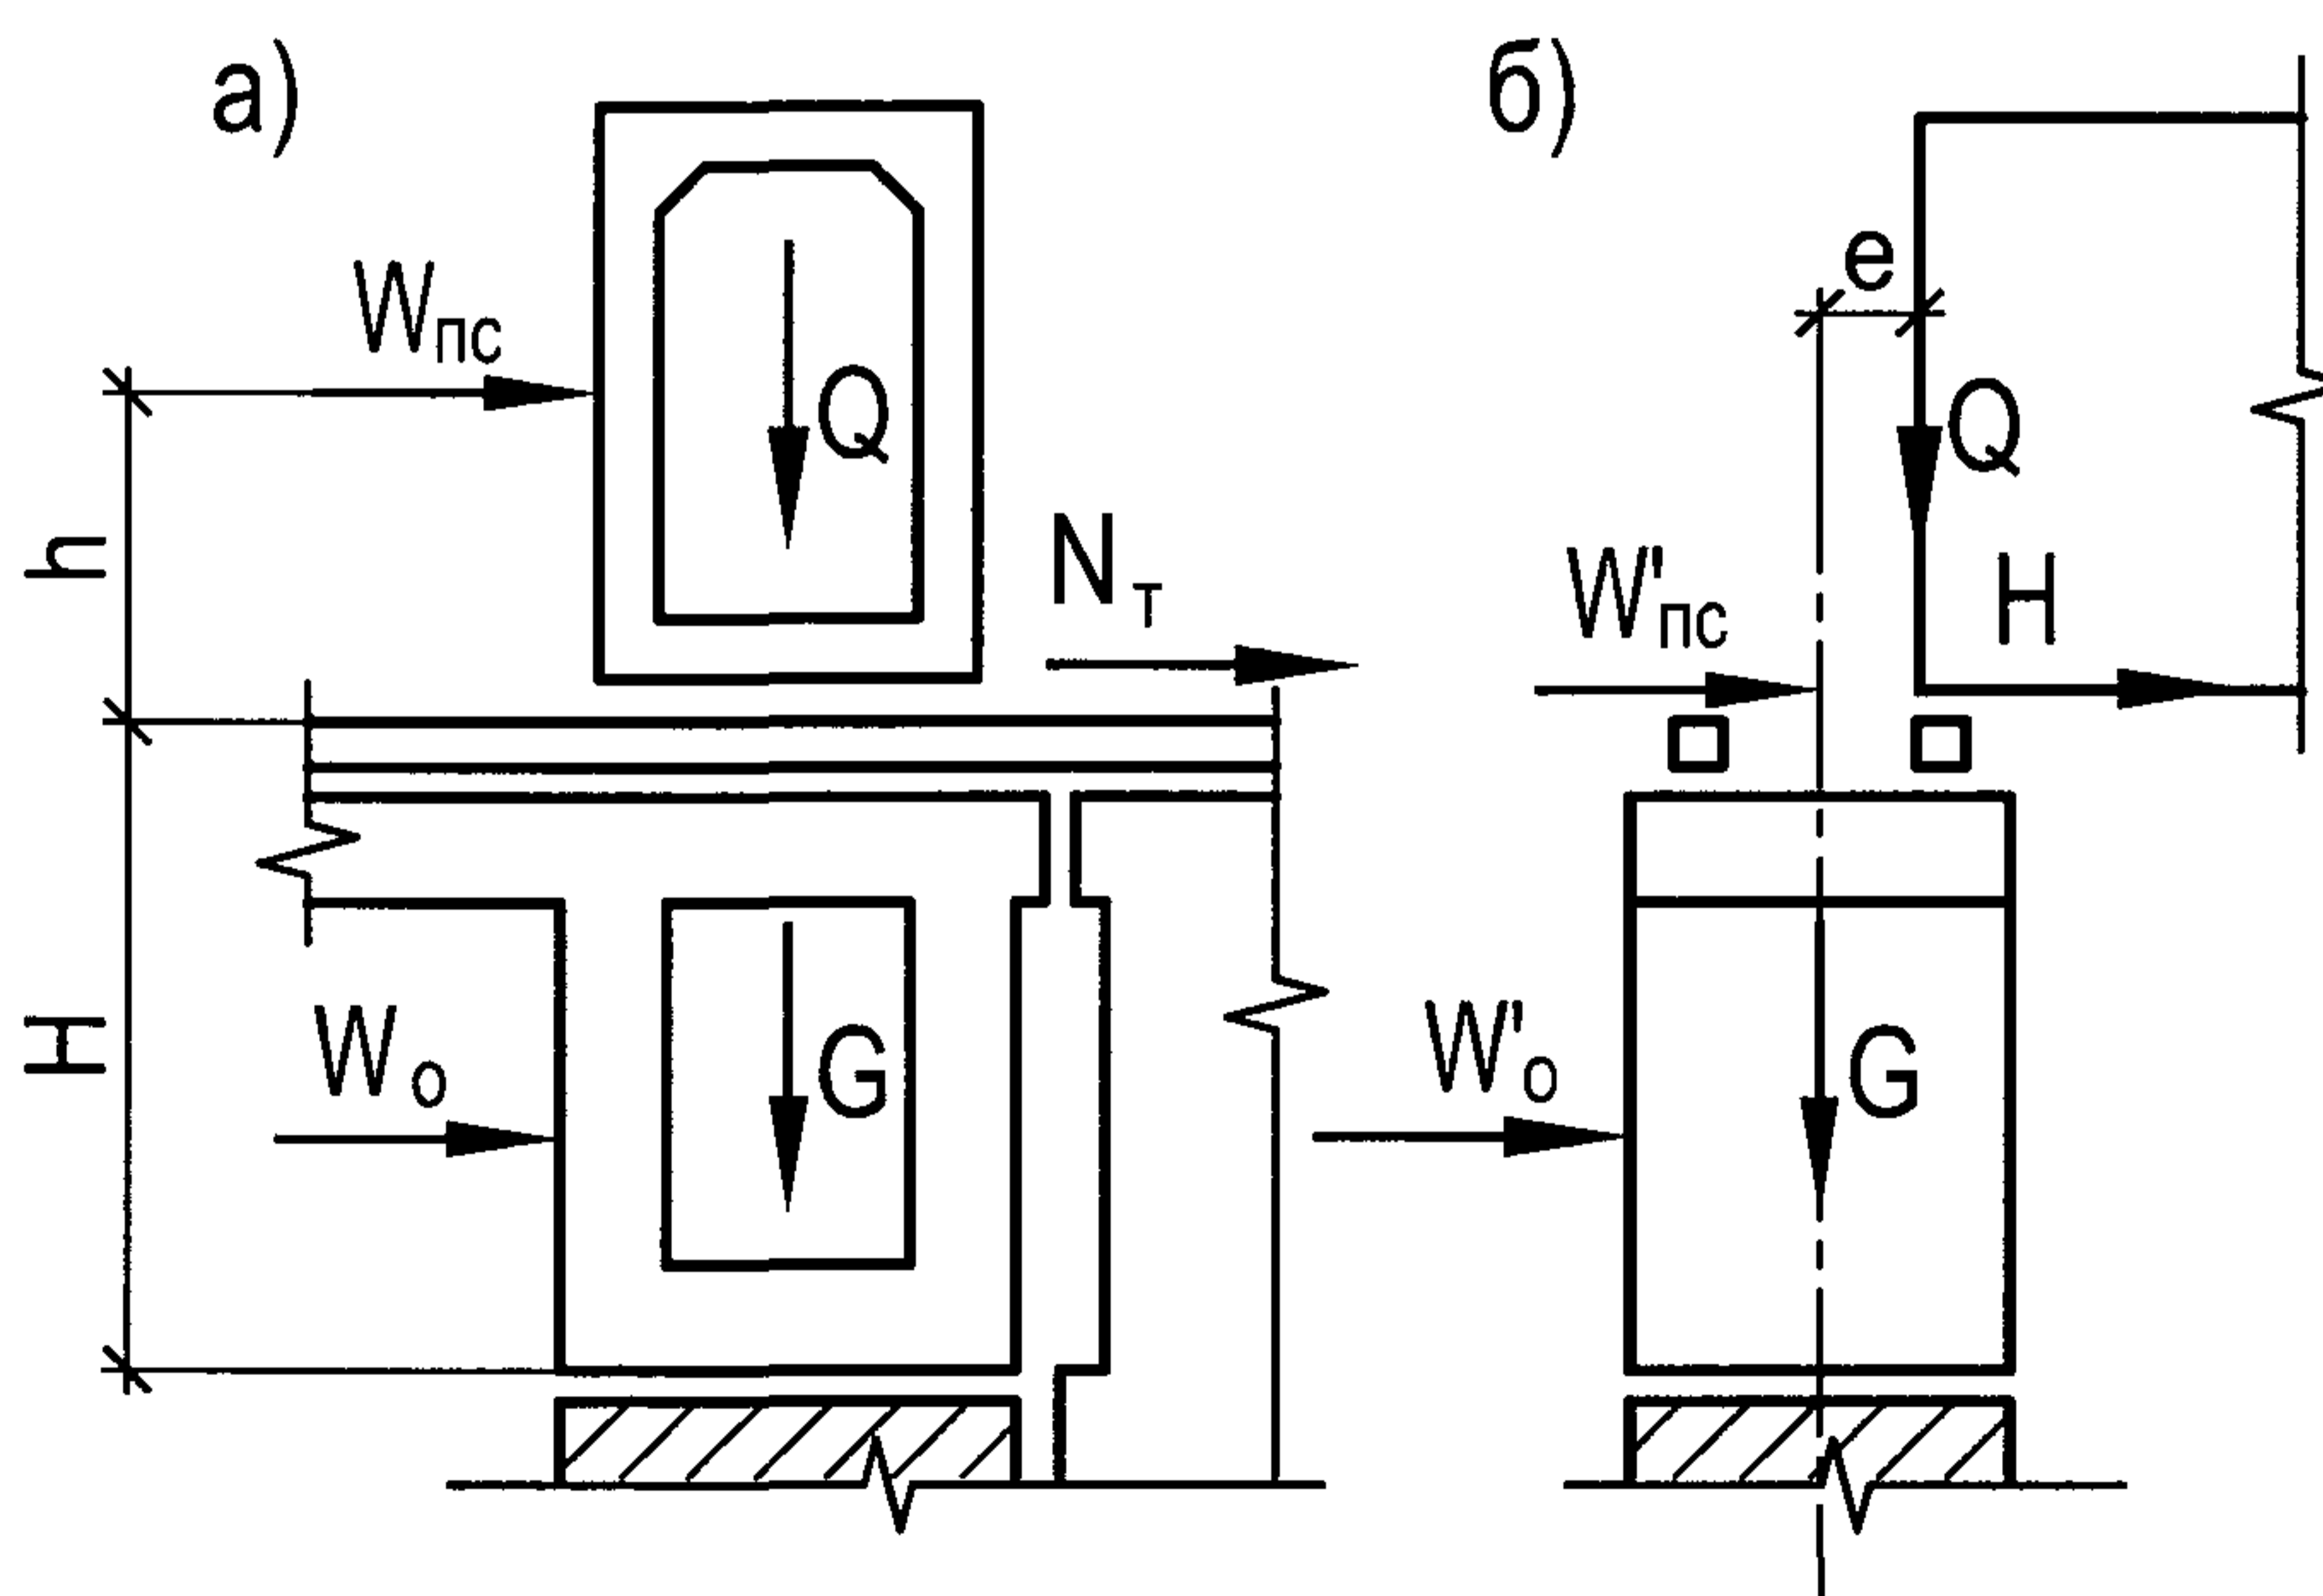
Схемы приложения нагрузок к пирсам.
